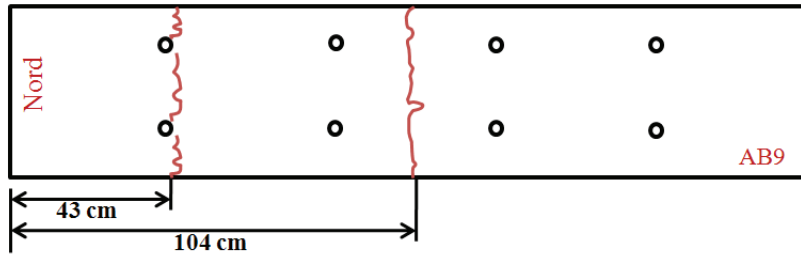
Relevé des fissures sur la poutre AB9
